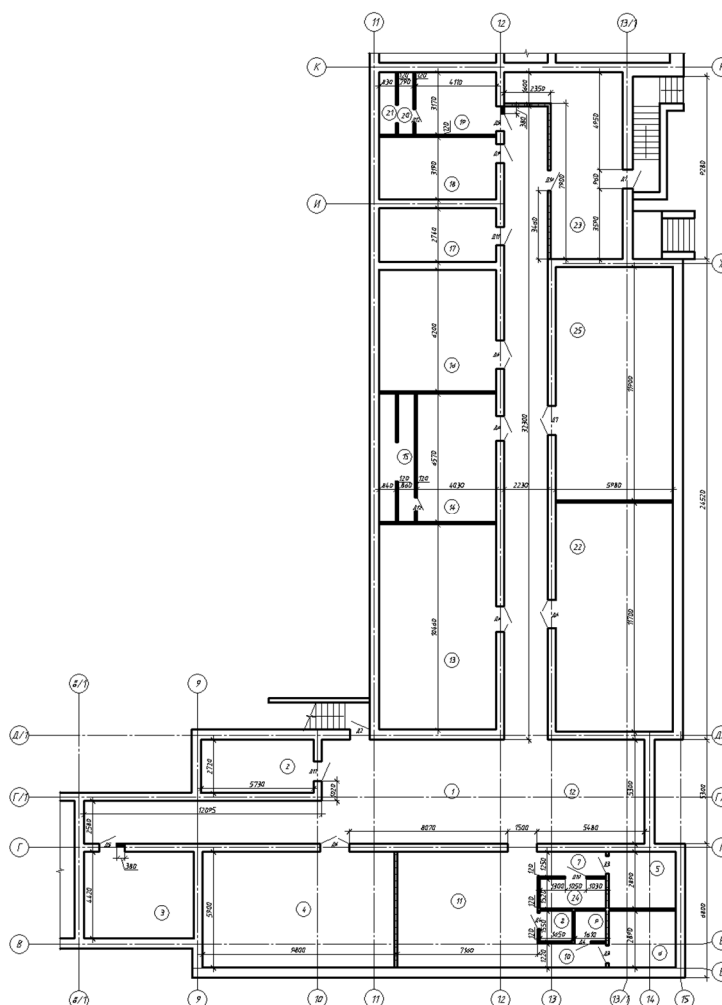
План підвального поверху в осях Б-К після реконструкції
